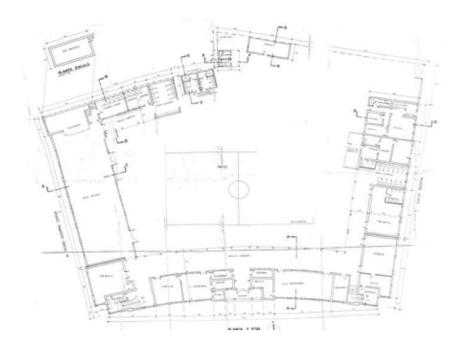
Planta primer piso Escuela Pedro Aguirre Cerda. [2]
